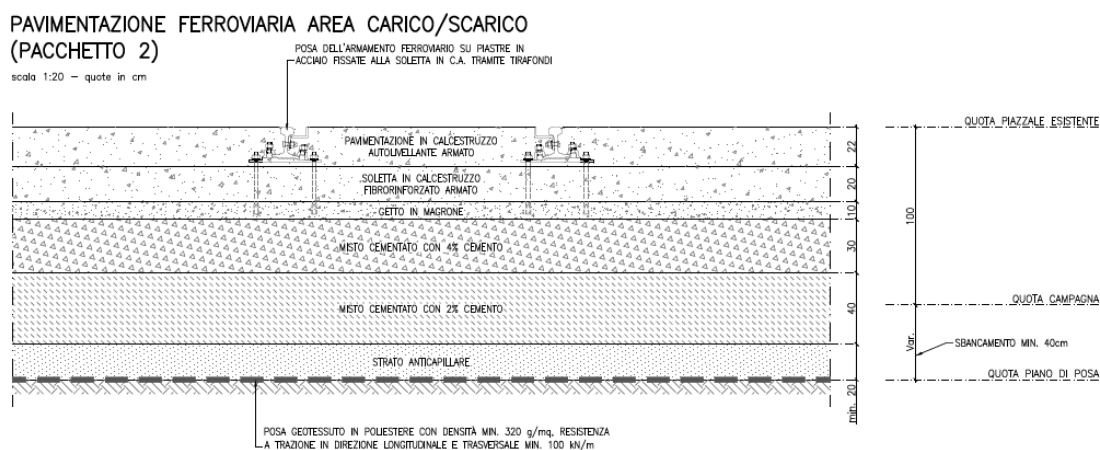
Estratto della tavola Sezioni Tipologiche: Pacchetto di pavimentazione per l'area di stazionamento
